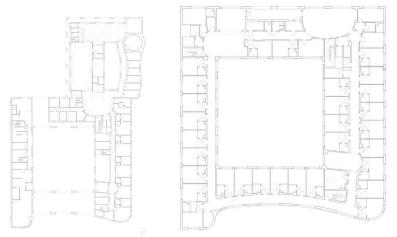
Дом престарелых De Drie Platanen / Бовенбау а) план первого этажа б) план типового этажа
